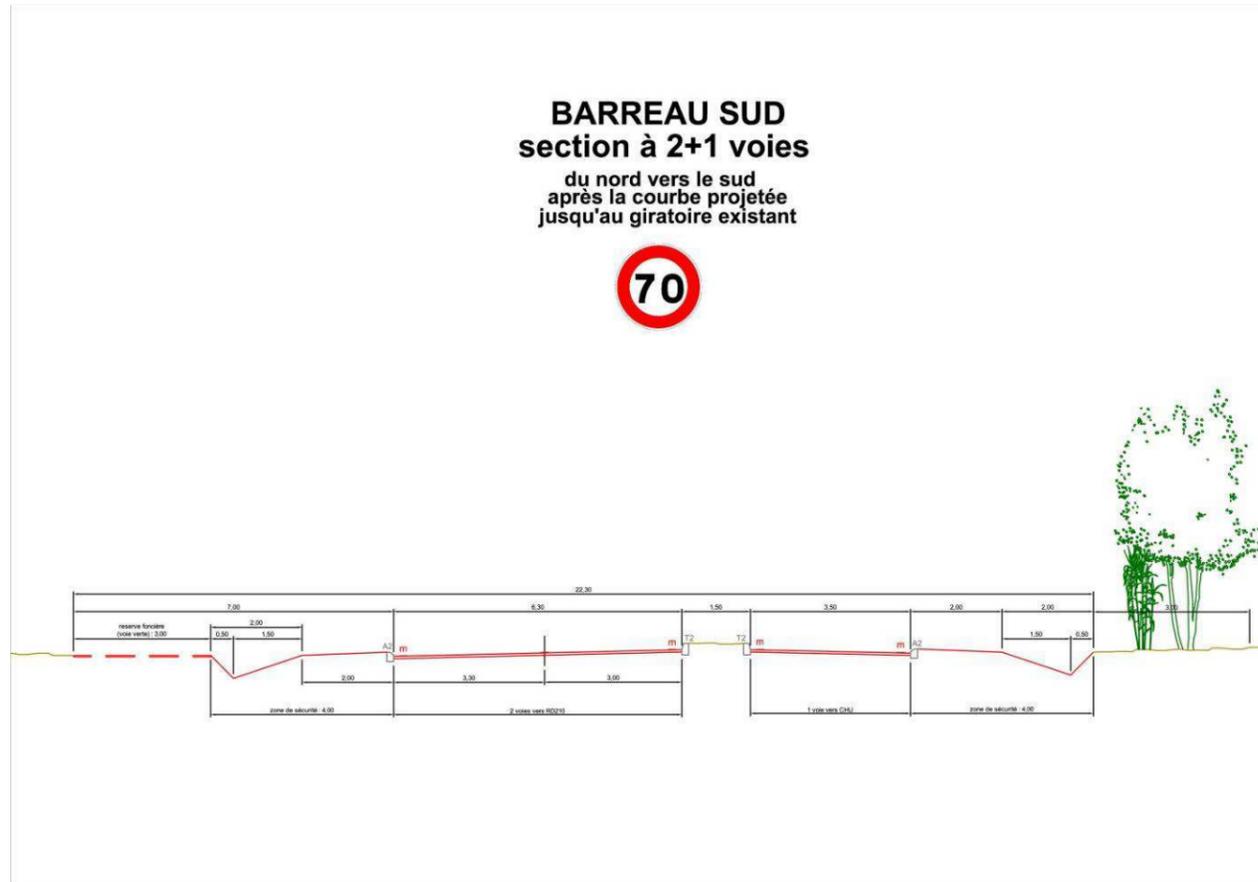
Profil en travers type du Barreau Sud sur la section à 2 + 1 voies
